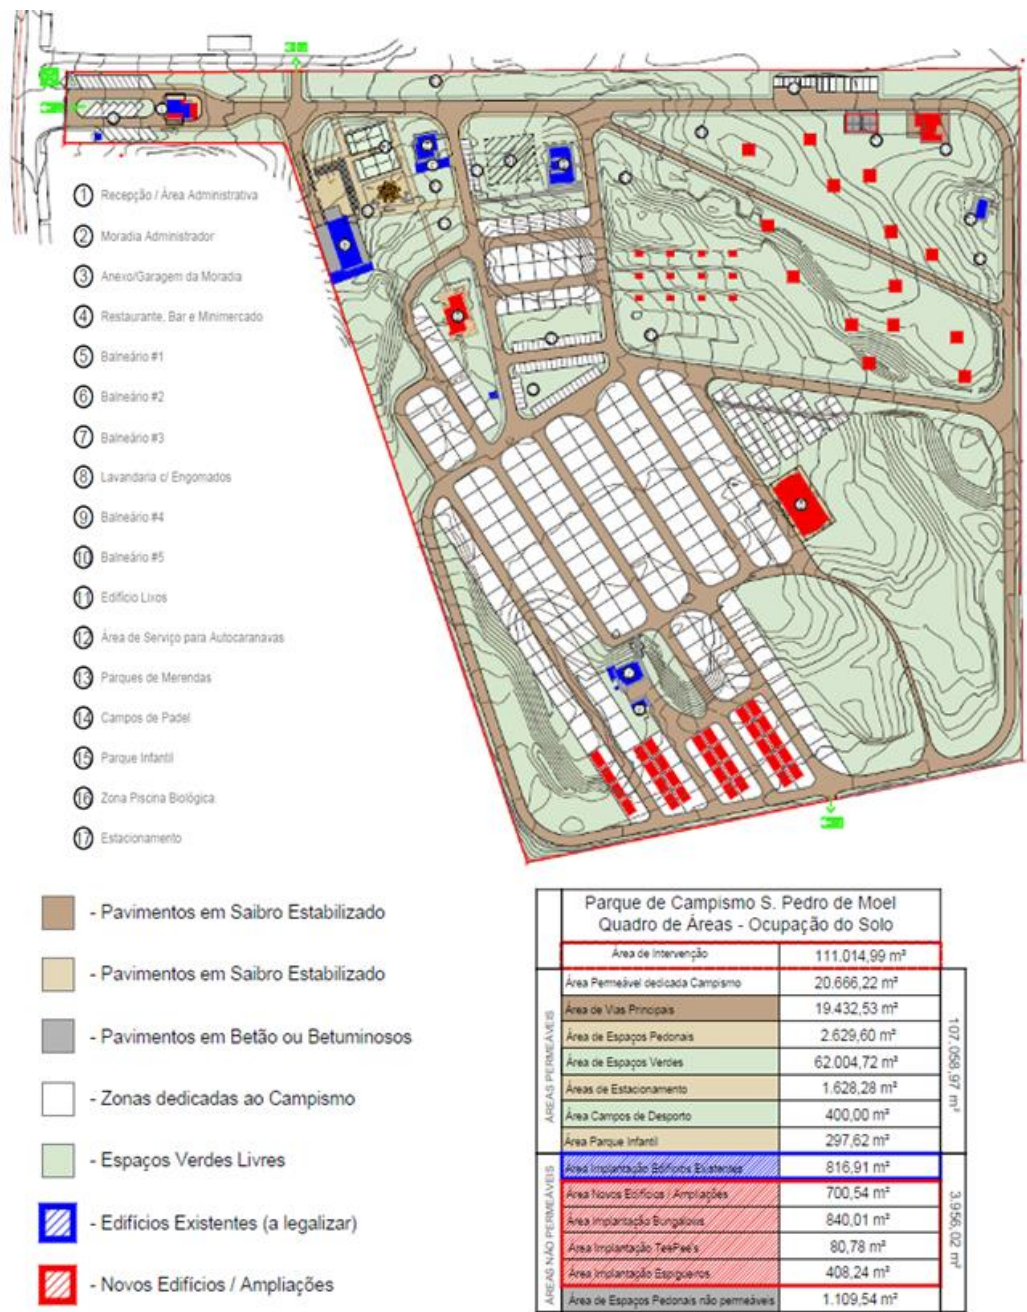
Planta de Implantação do Projeto. Fonte: Resposta a alegações.
